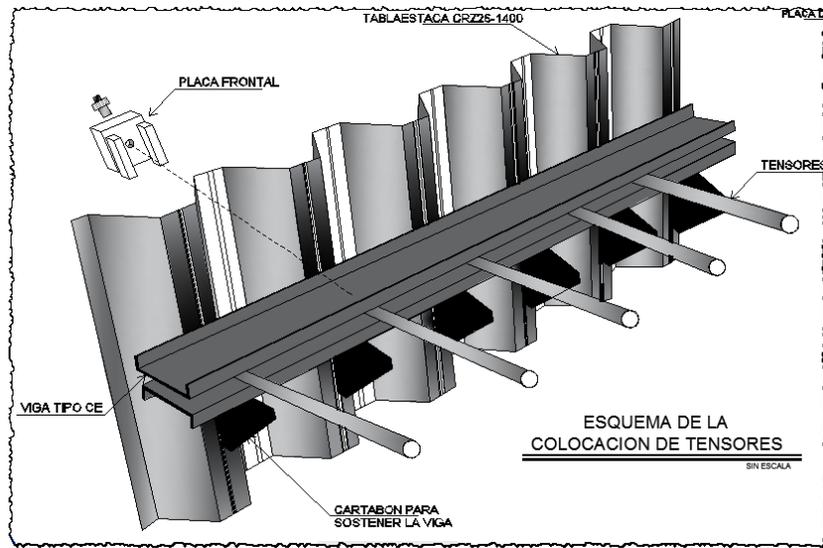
Colocación de viga tipo CE para evitar el pandeo de la tablaestaca CRZ.
